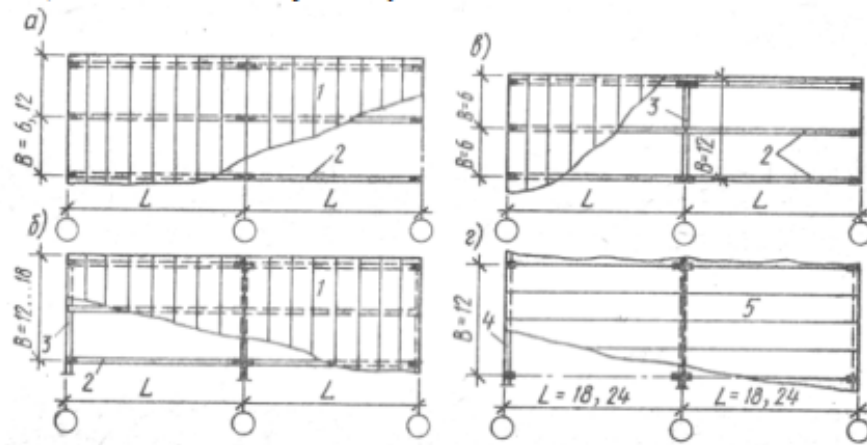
Варианты компоновки покрытия (размеры в м): 1 — плиты покрытия; 2 — стропильные конструкции; 3 — подстропильные конструкции; 4 — продольные стропильные конструкции; 5 — плиты покрытия «на пролет»
